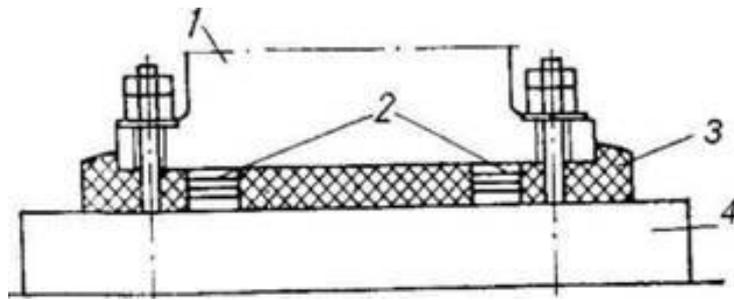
Схема установки оборудования на фундамент с опиранием на пакеты подкладок:
